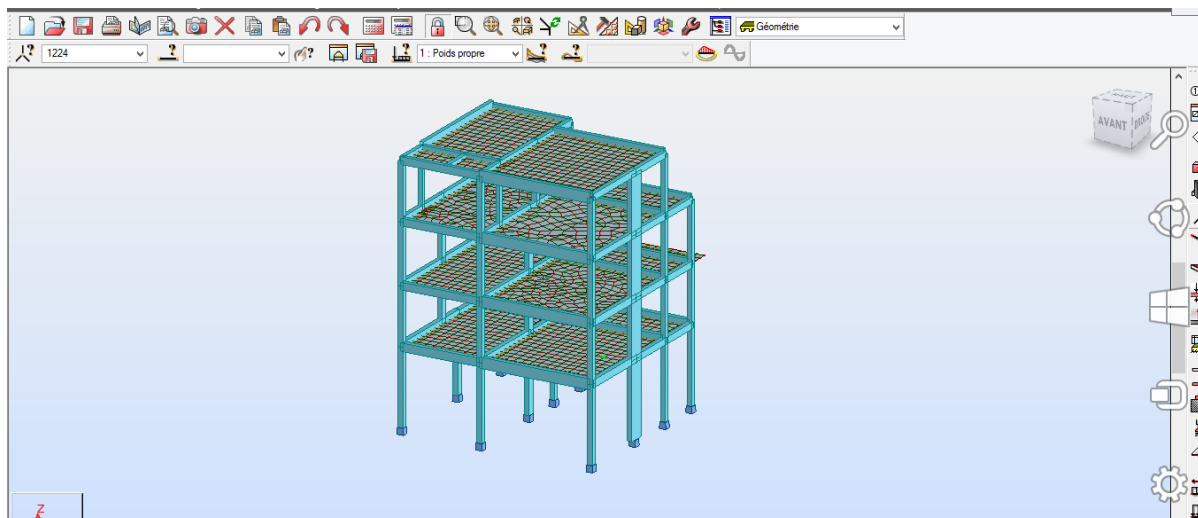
MODELISATION DU JOINT 23 EN DALLE PLEINE SUR AUTODESK ROBOT
